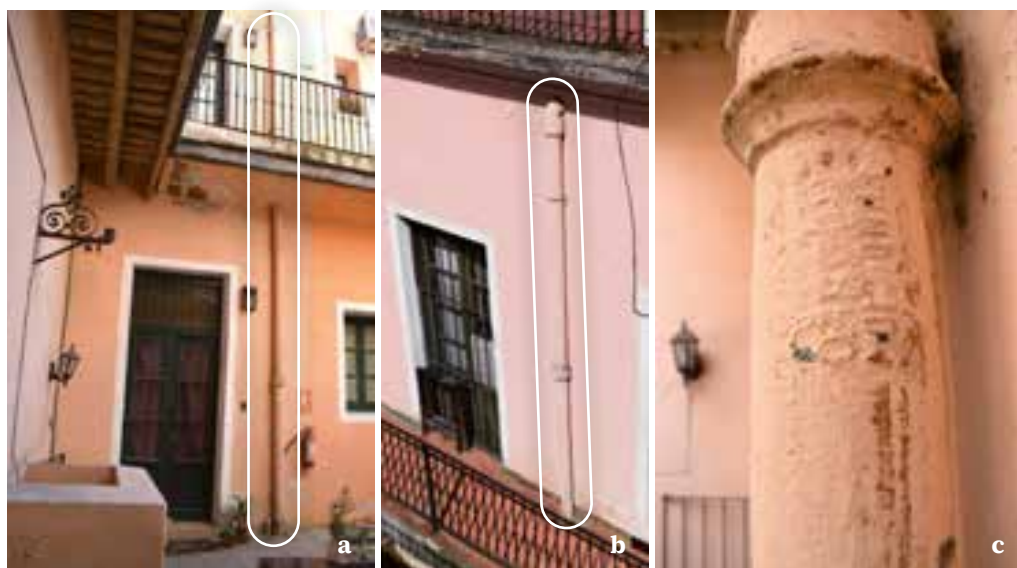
Aljibe ubicado en el segundo patio del Solar de Burgues, construcción representativa de las primeras décadas del siglo XIX. 36b. Se observa la canalización de la planta alta. 36c. Detalle del caño en hierro fundido con la marca «Fundición Modelo». Calle Ituzaingó, en Ciudad Vieja. Caso n.º23
